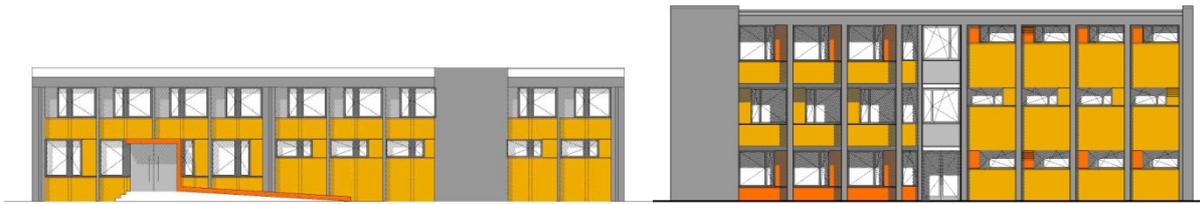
Fassadenkonzept Verwaltung und Kreuzbau
